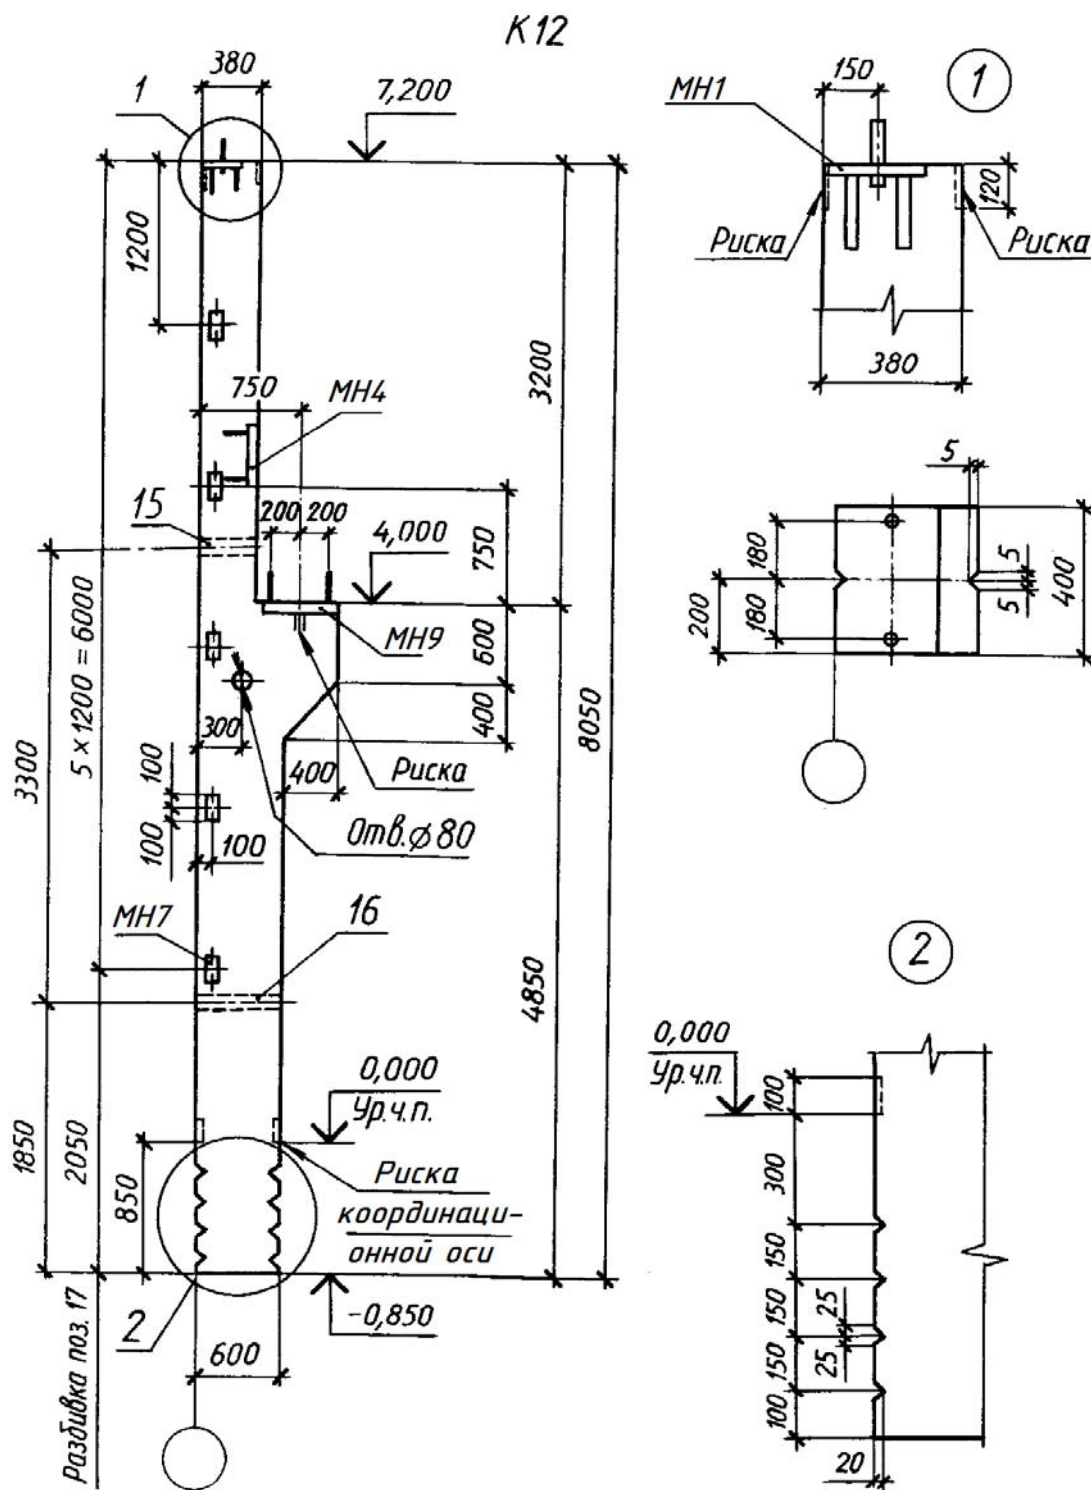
Общий вид сборной железобетонной колонны
